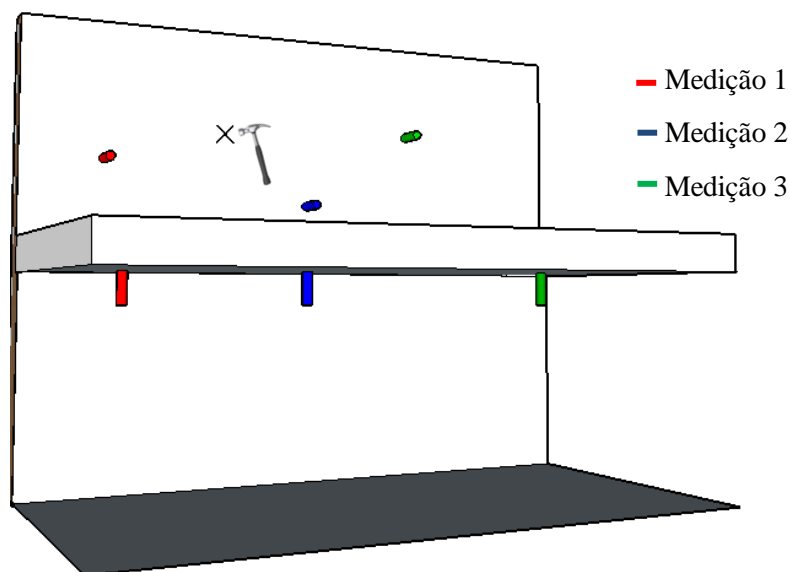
Esquema de ensaio para caracterização do caminho de propagação parede piso 2/pavimento
